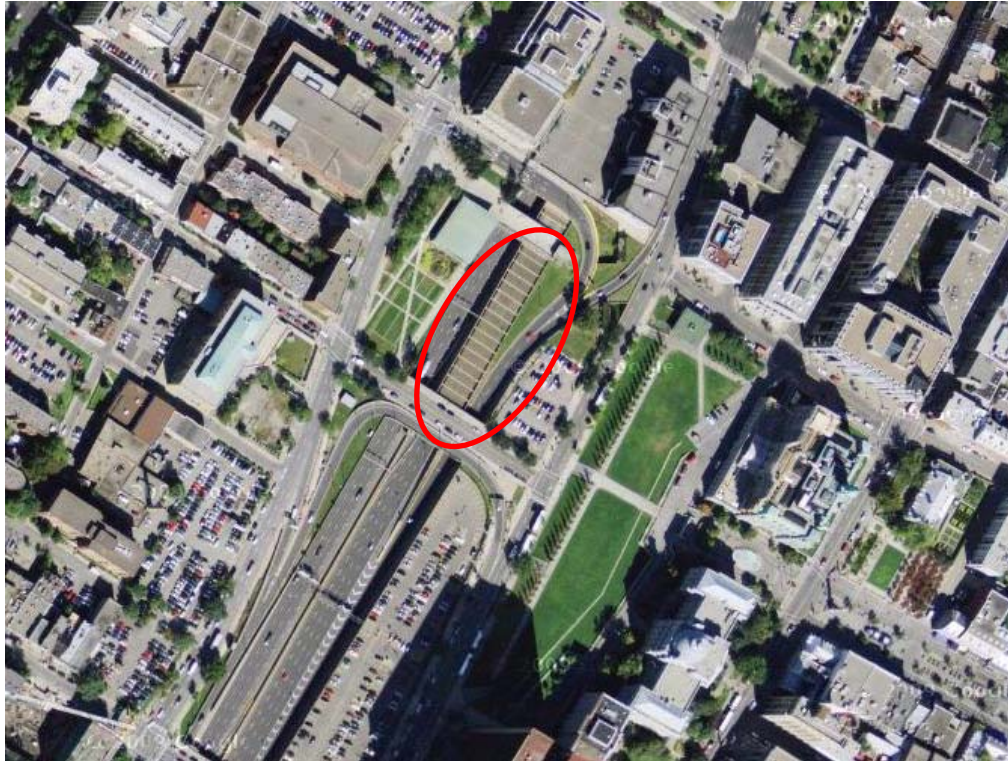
Photo aérienne de l'entrée ouest de la voie B du tunnel Viger
